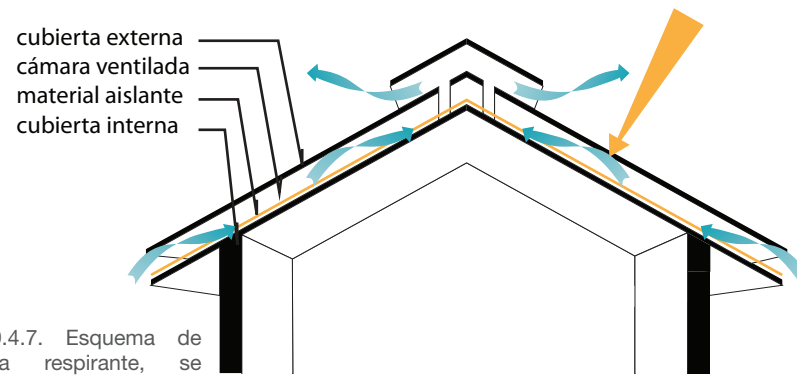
Esquema de cubierta respirante, se pueden utilizar cenefas o aleros ventilados, lagrimeros o cenefa para permitir el ingreso de aire por la parte inferior de la cubierta (elaborado por autores).
